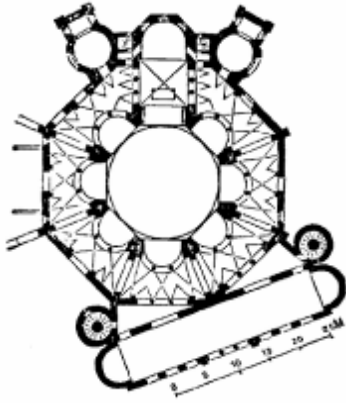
Grundriss, San Vitale, Ravenna, 522 bis 548,
